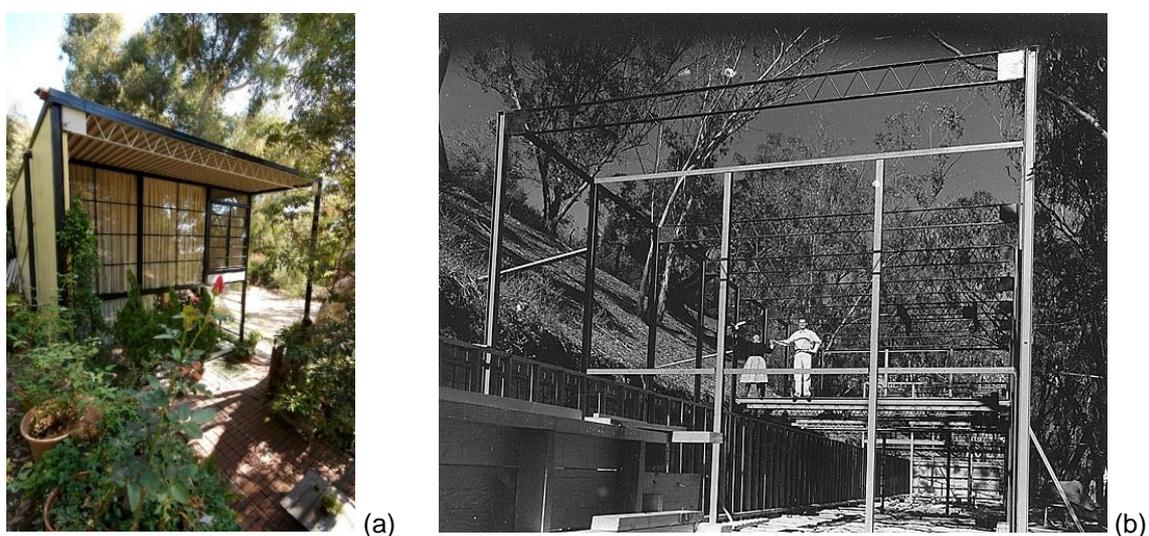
Casa N°8: (a) bloco da casa N° 8 (b) pórtico metálico
